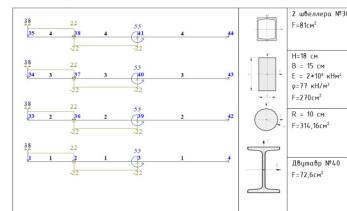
Заданная балка: а) схема балки; б) расчетные схемы балок.
